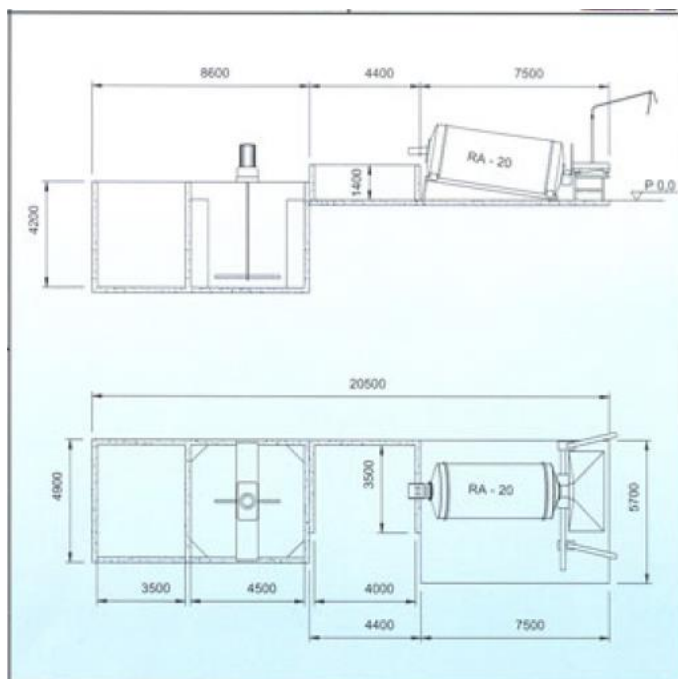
Exemplo de Desenho Esquemático da Central de Concreto
